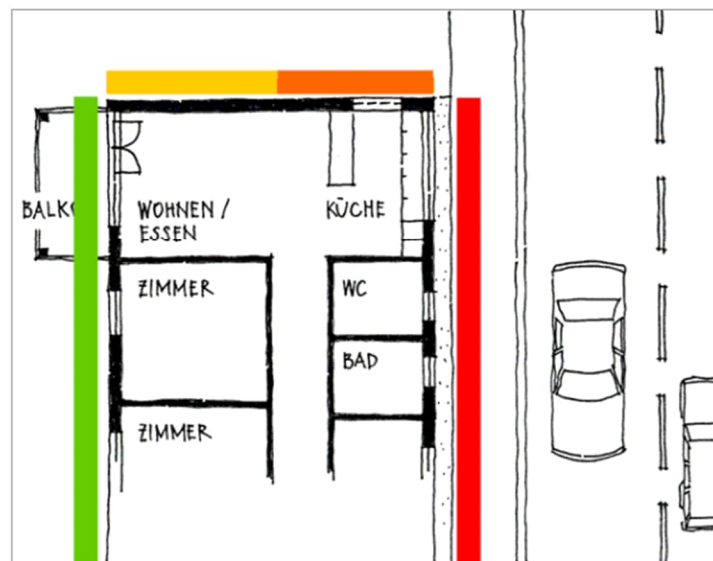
Lärmoptimierter Grundriss mit Lärmreduktion in dB (Quelle: «Bauen im Lärm»)
